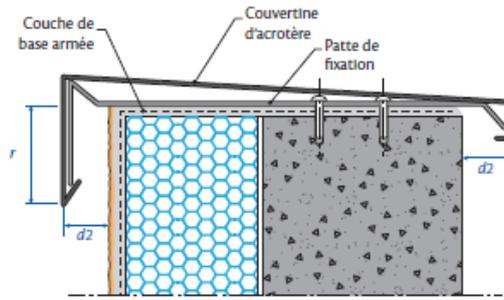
Fermeture de la lame d'air par l'enduit sur un arrêt sur acrotère
